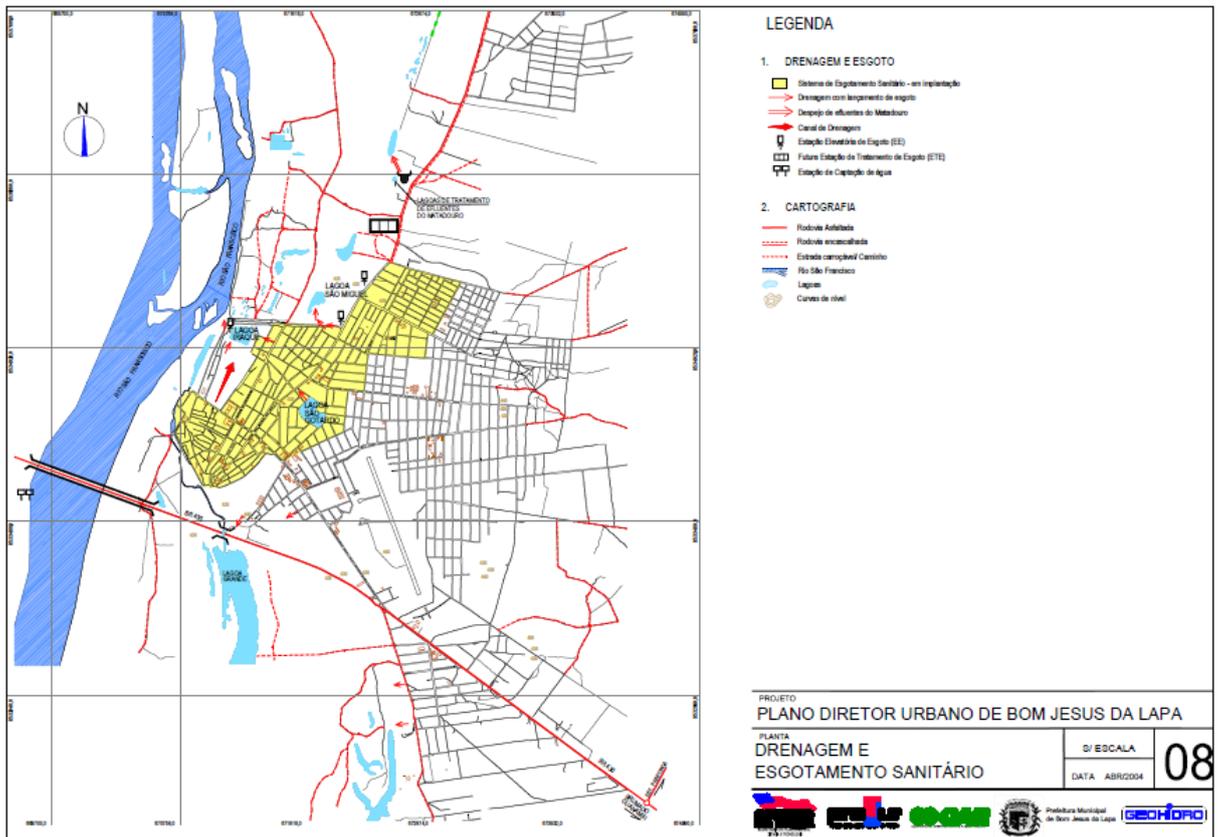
Planta de drenagem e esgotamento sanitário - 08
